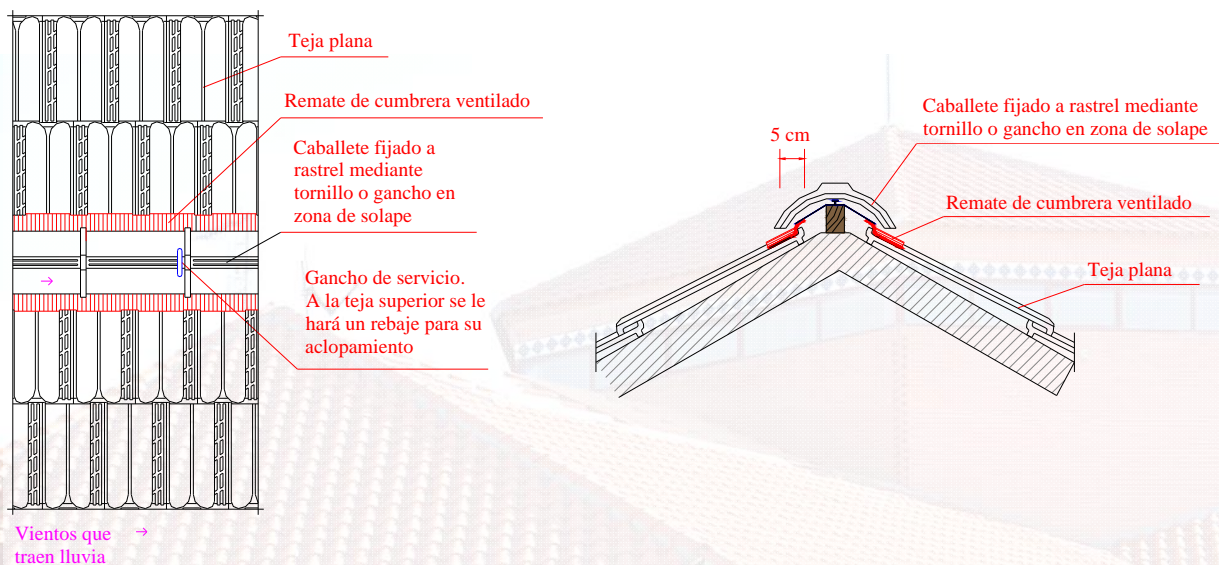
y Figura 72. Planta y sección de cumbrera con teja plana
